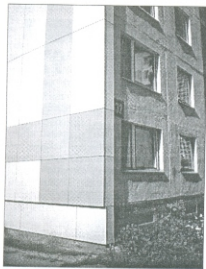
Реконструкция фасада жилого дома в Бильясто
